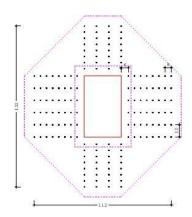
Схема армирования плиты в зоне колонн
